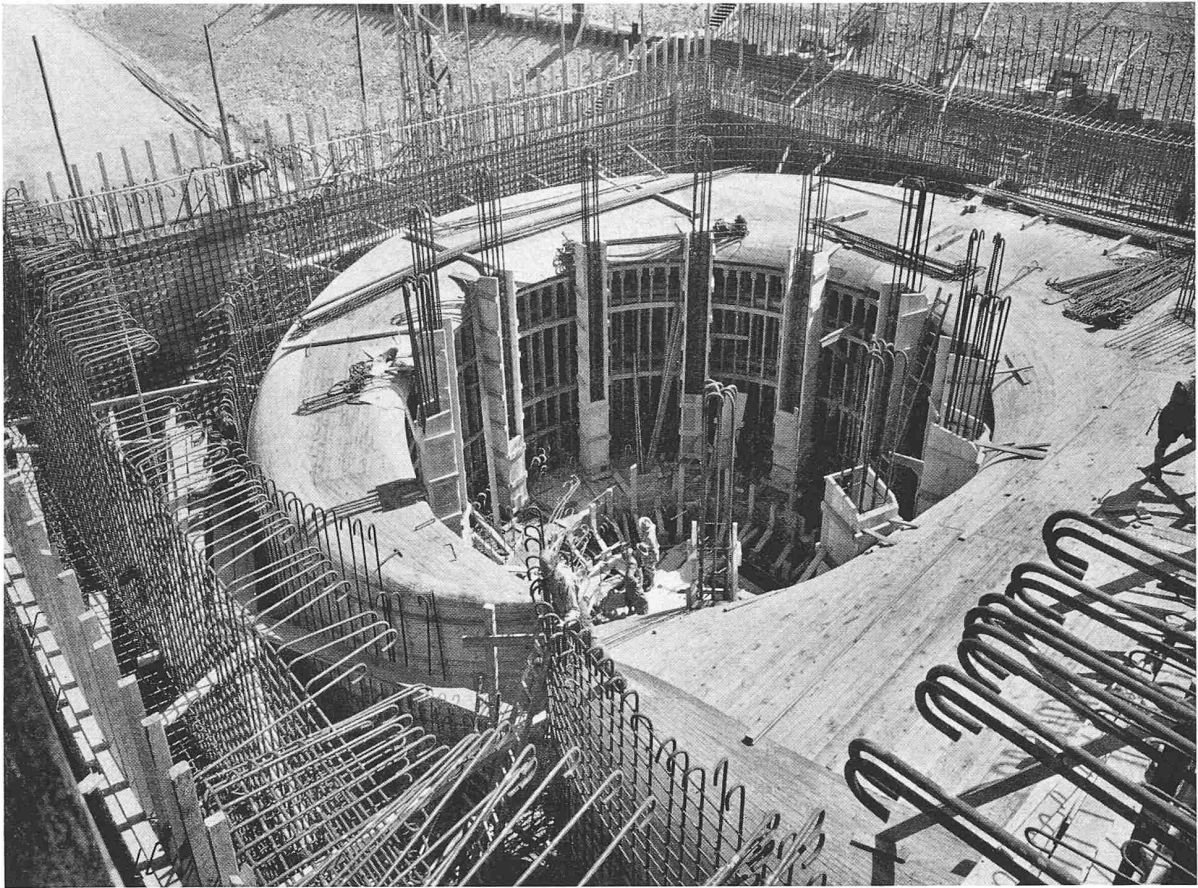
Maschinenhaus. Schalung der Einlaufspirale für Maschinengruppe 2. 23. August 1950
